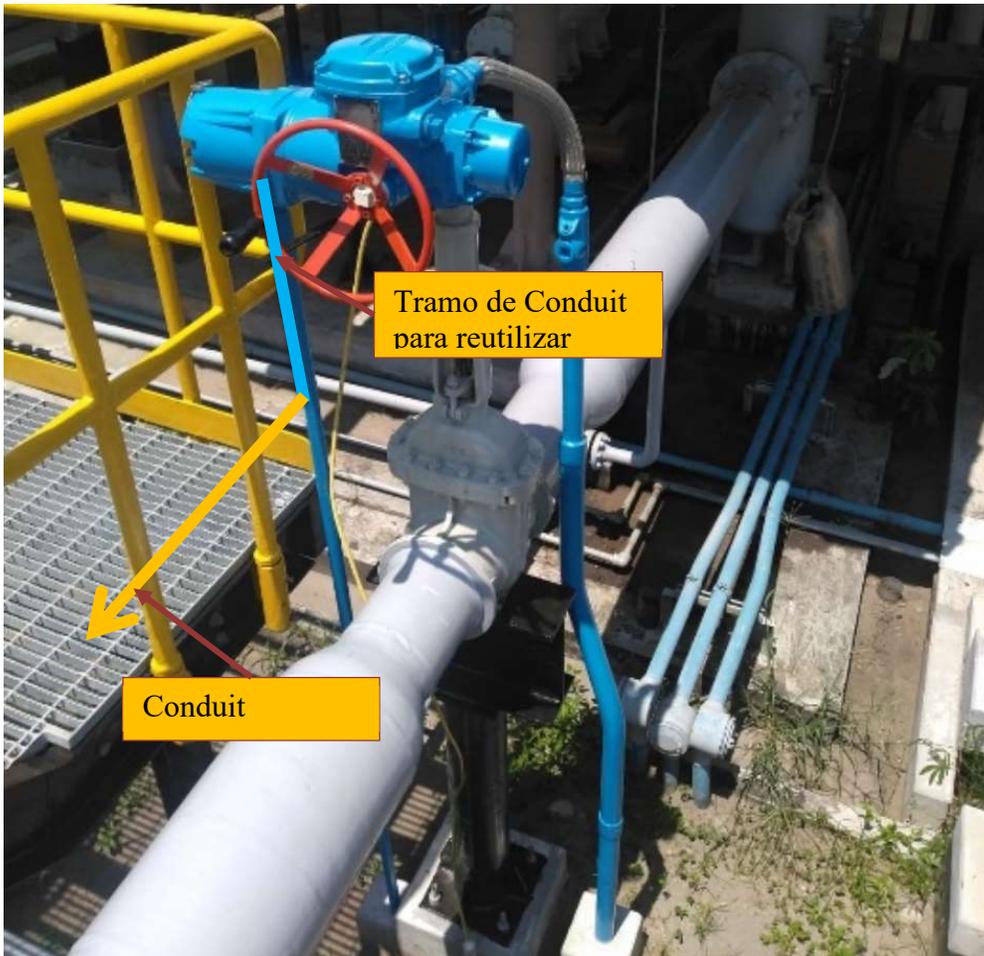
tubería conduit proyectada para cables de control remoto de actuator.
